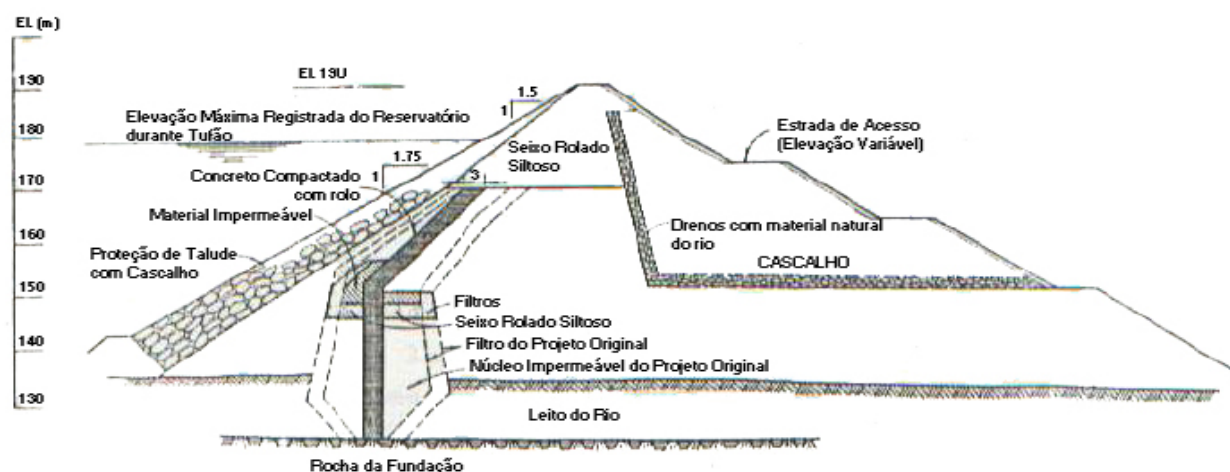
Seção transversal da ensecadeira da Barragem de Shimen – Primeira utilização do CCR (PACELLI DE ANDRADE, 1991).
